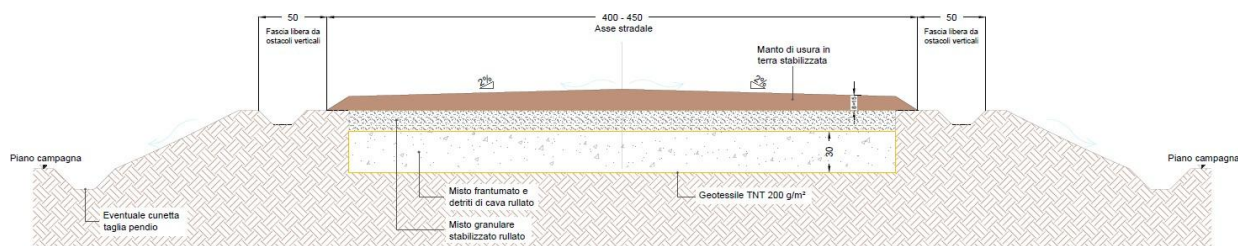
Sezione tipo pista di impianto su rilevato; misure in centimetri
